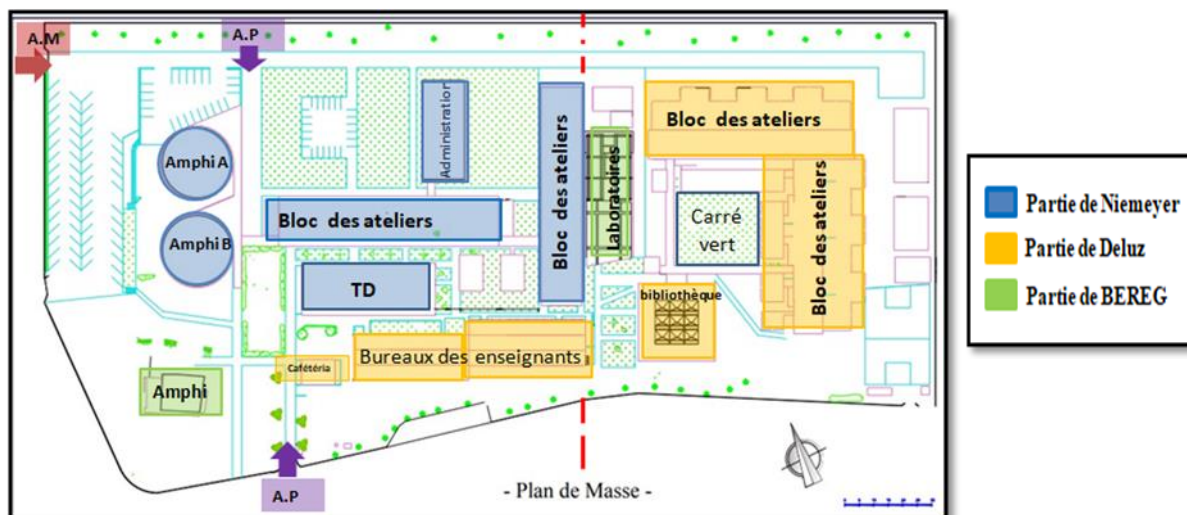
Plan de masse de l'EPAU Source : Auteurs
